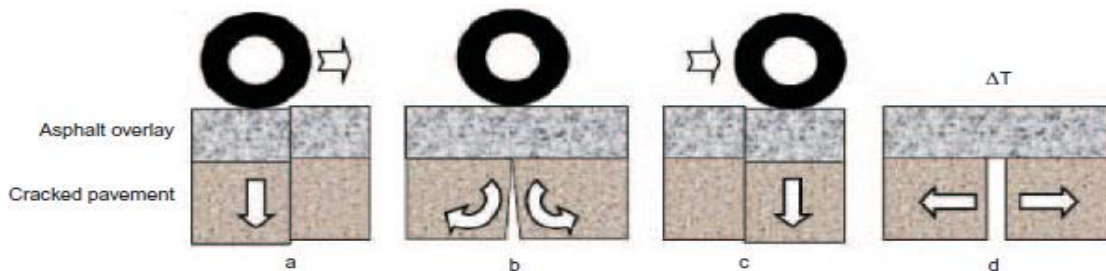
Metodología de formación de grietas en juntas de construcción.
